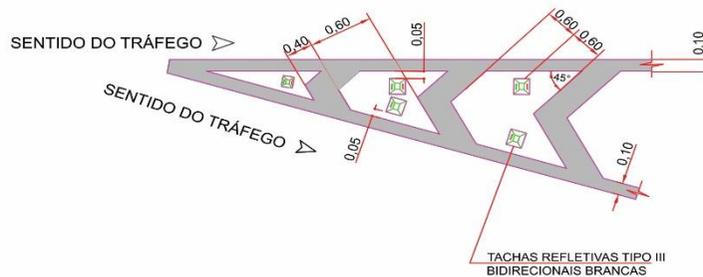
Detalhe para colocação de faixa longitudinal e tacha
